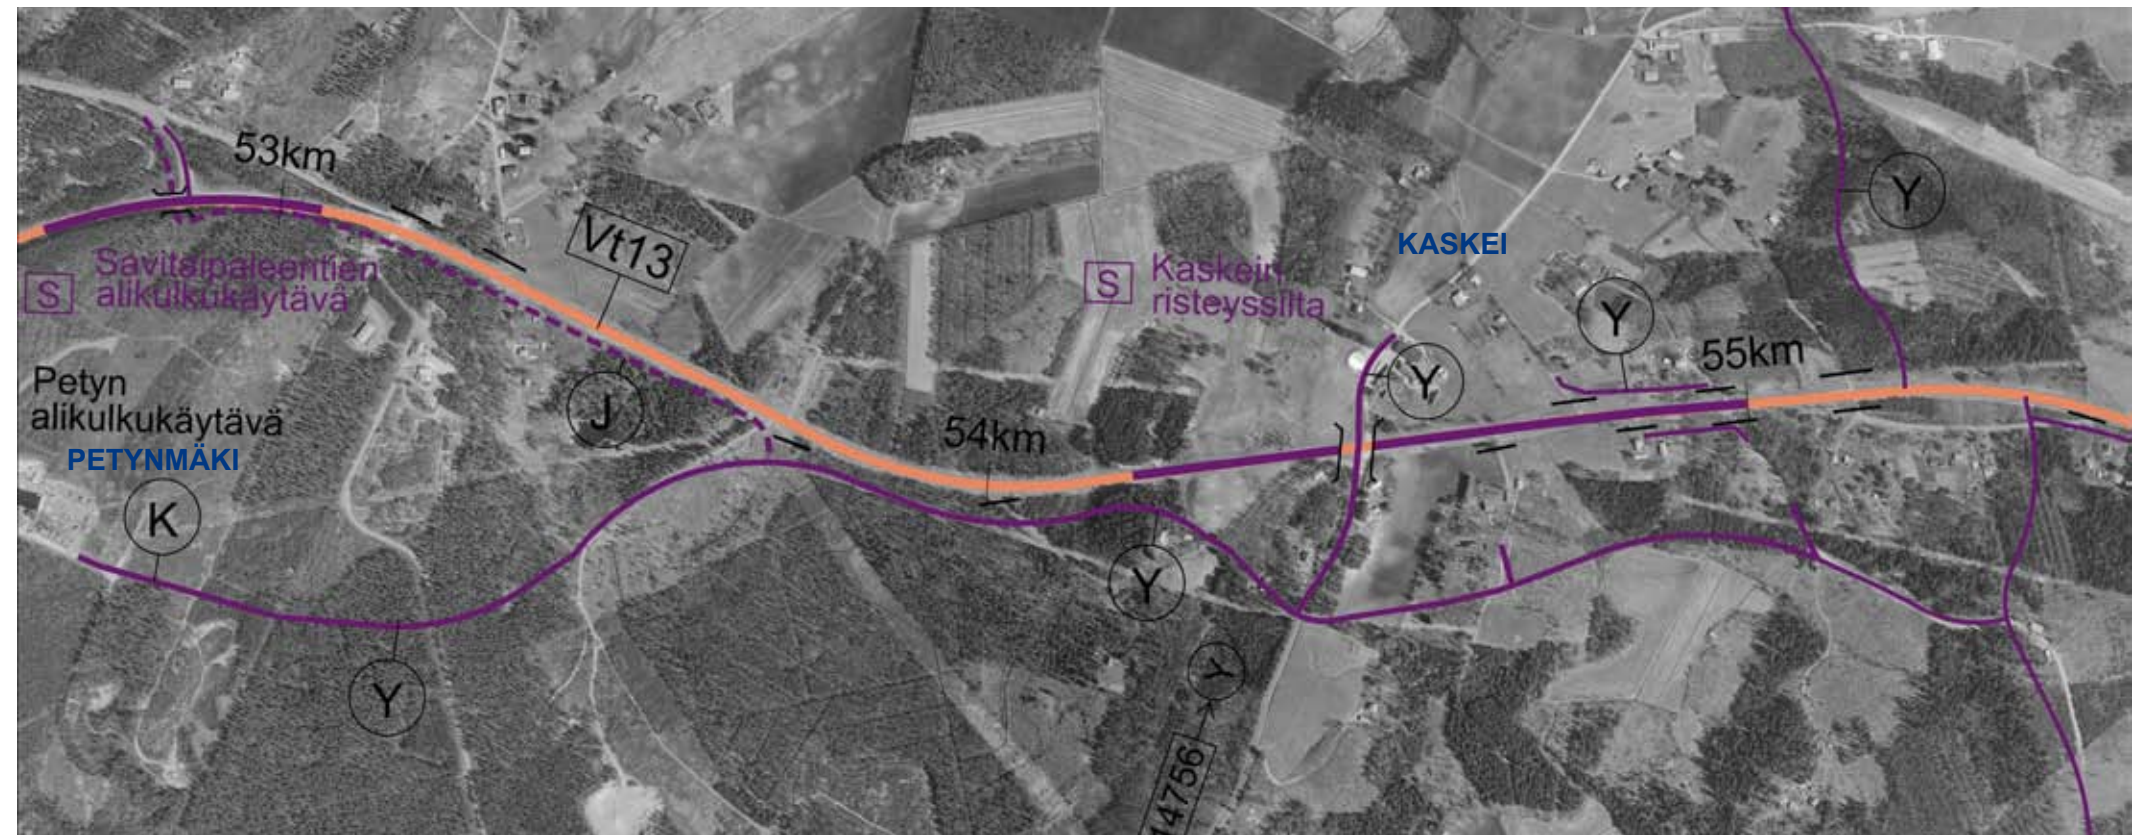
TOIMENPIDE 24, M409 Savitaipaleentien liittymän parantamisen toimenpiteet
